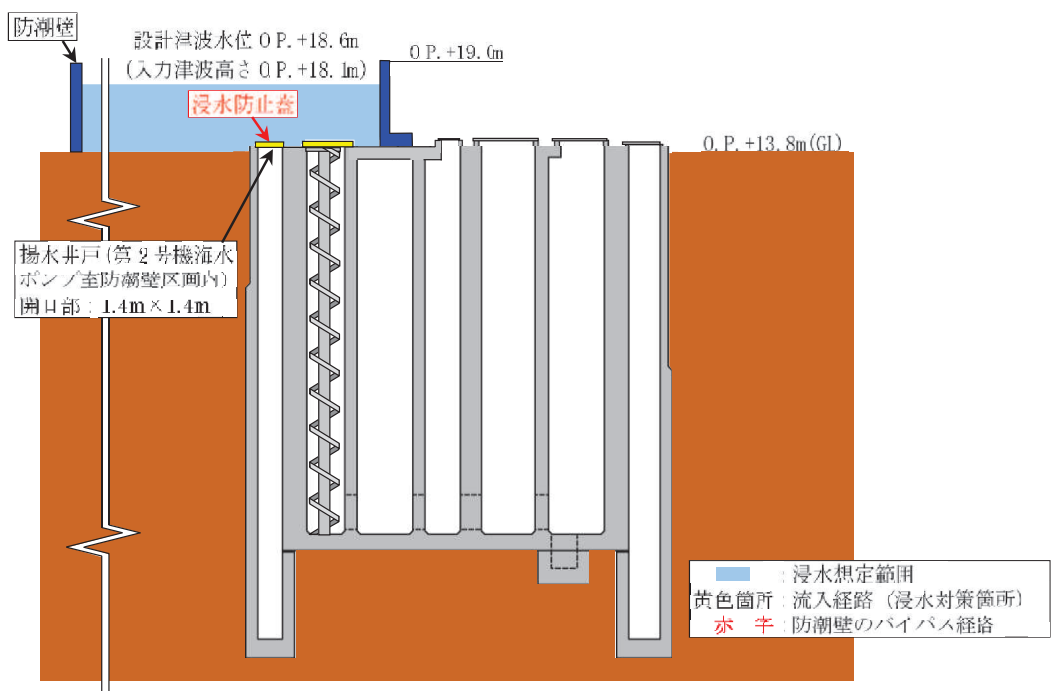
(2) 第 2 号機 海水ポンプ室 流入対策配置図 (B-B 断面図)
